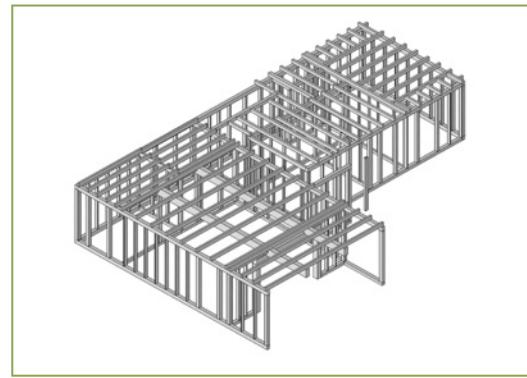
Deckenbalkenlage mit nahezu ebener Dachterrassenkonstruktion
